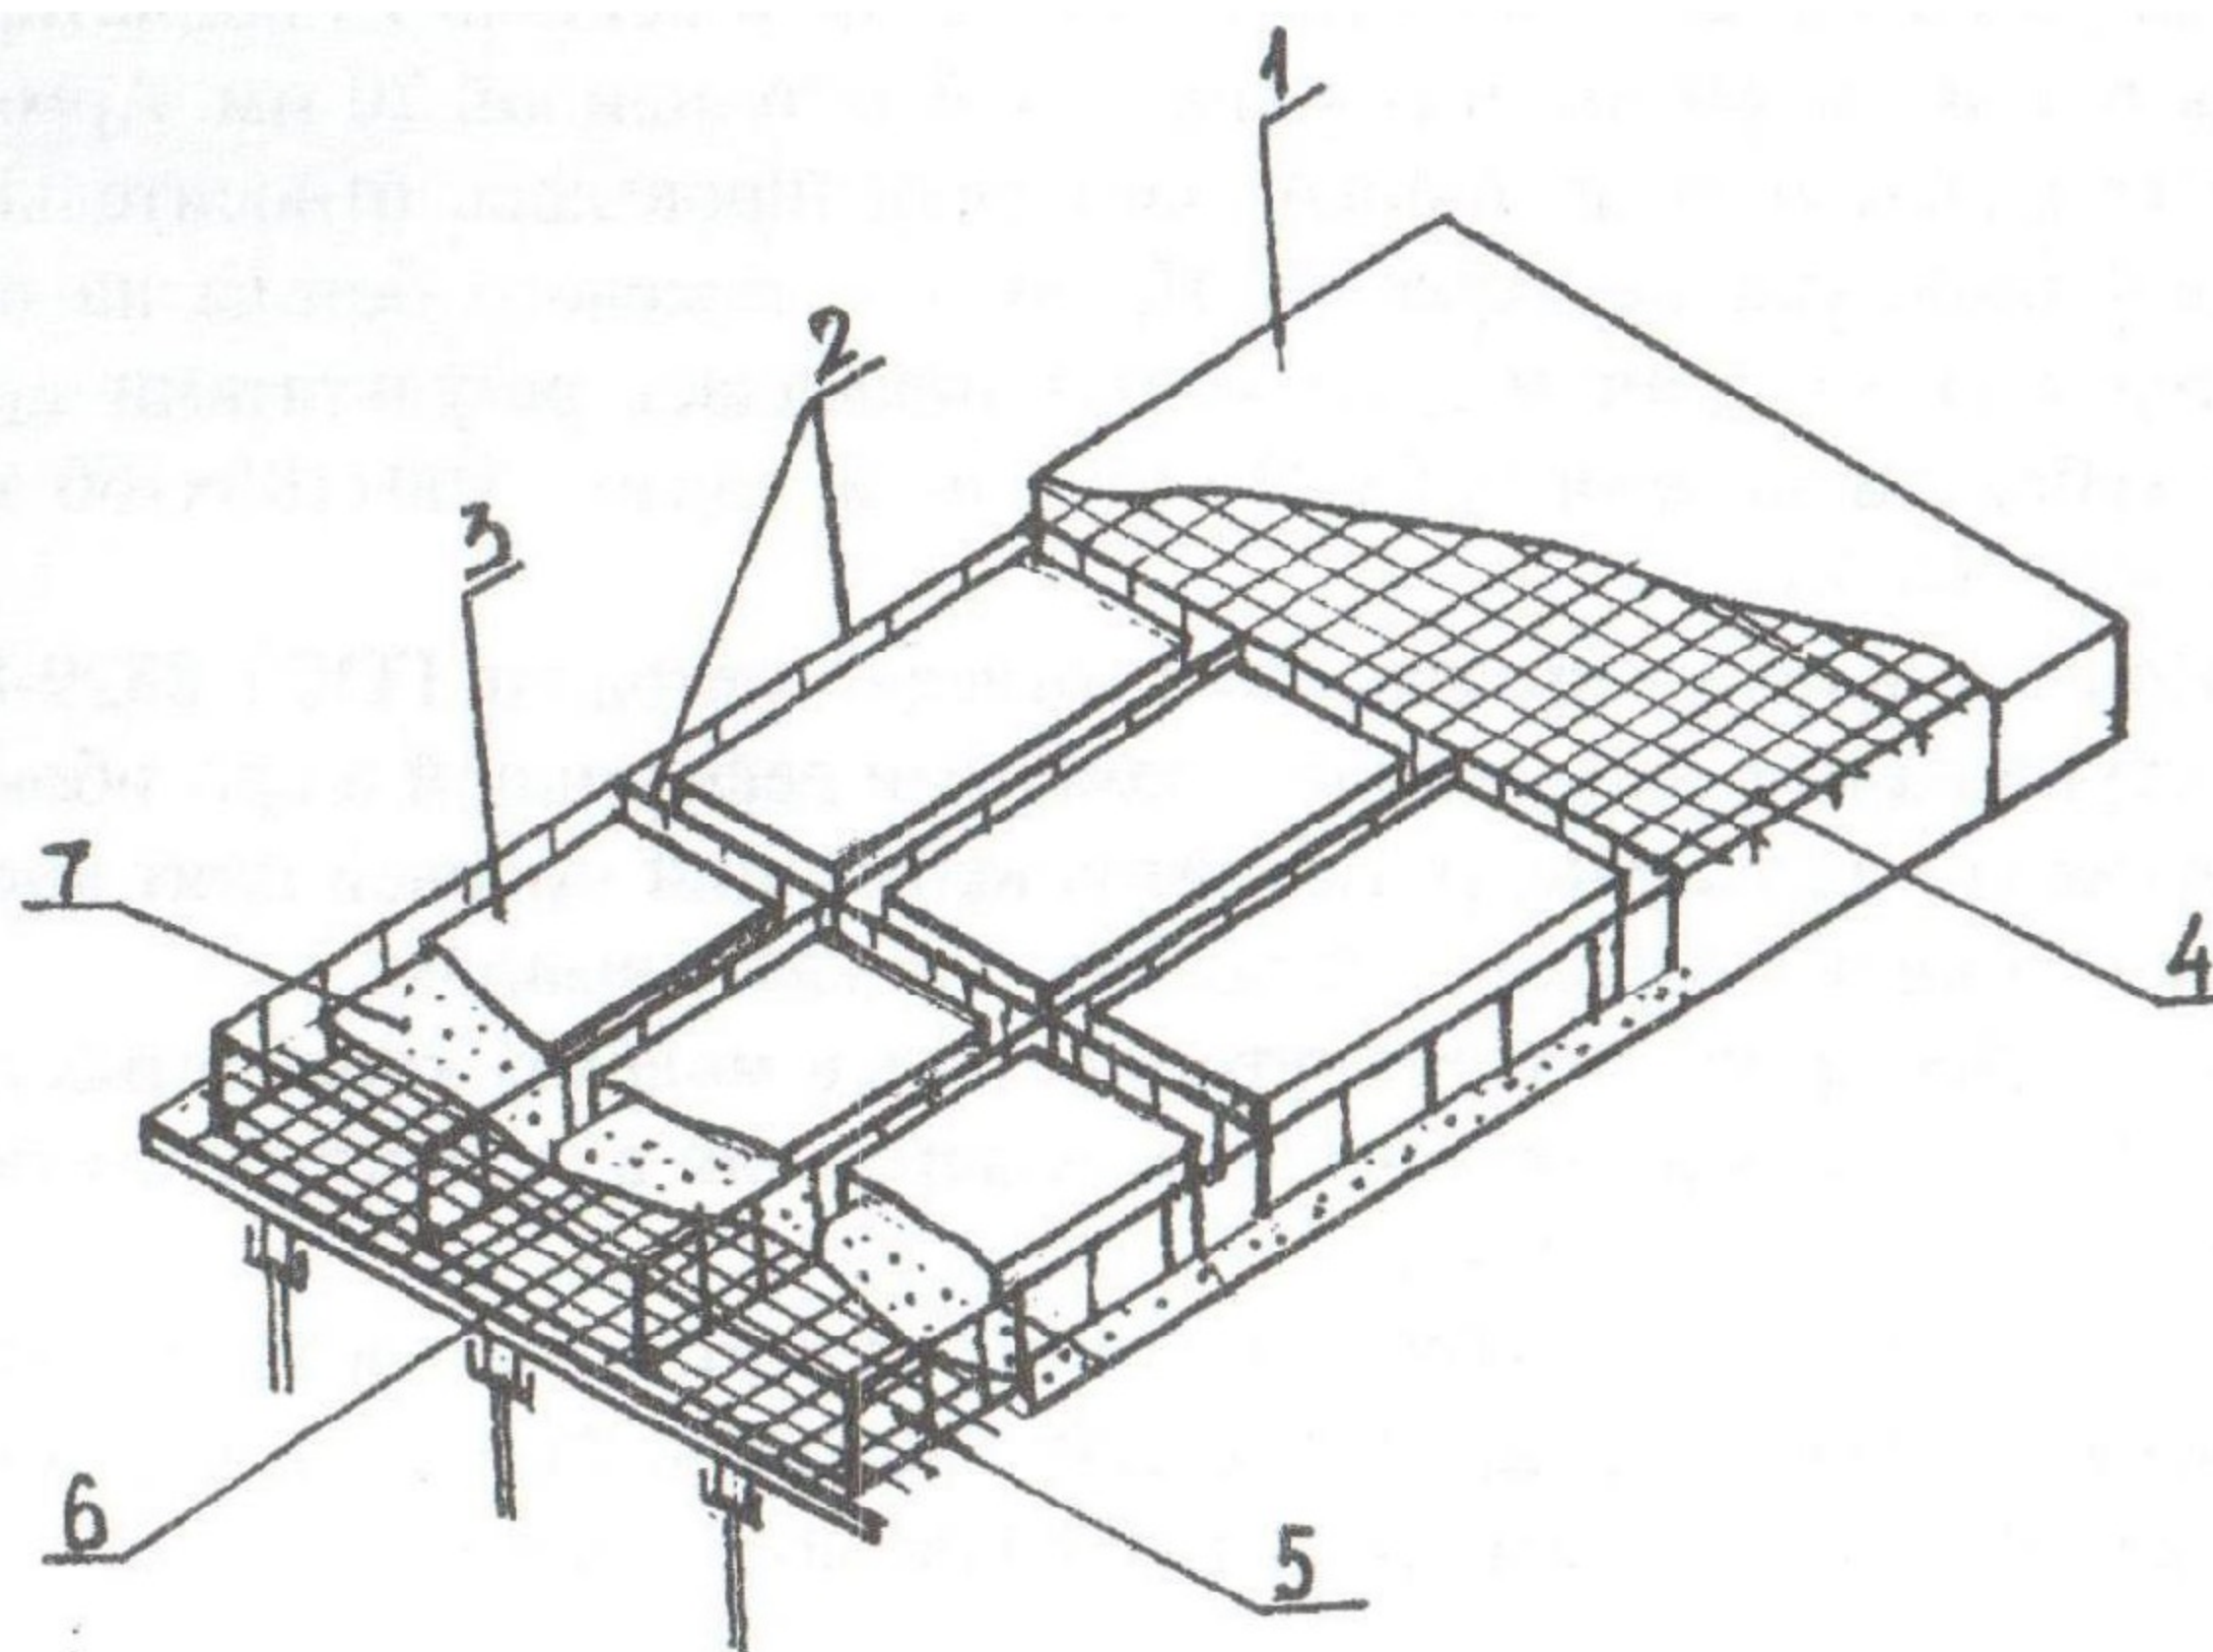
Коробчатые перекрытия из монолитного железобетона:
